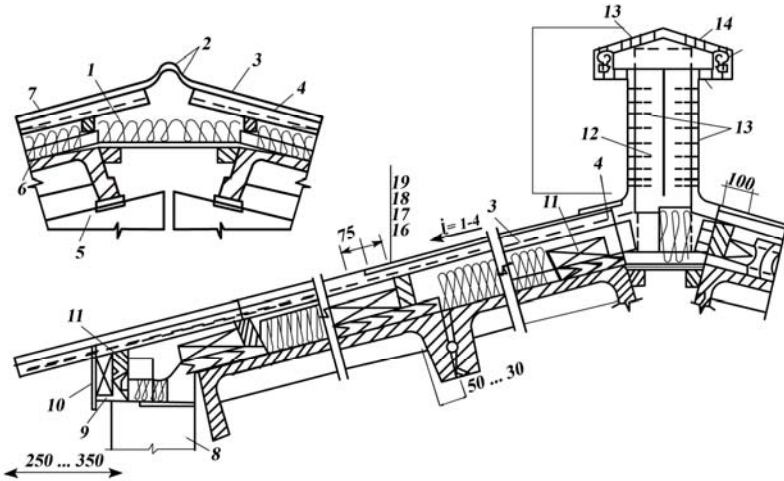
Суміщене вентиляване покриття з азбестоцементною покрівлею:
